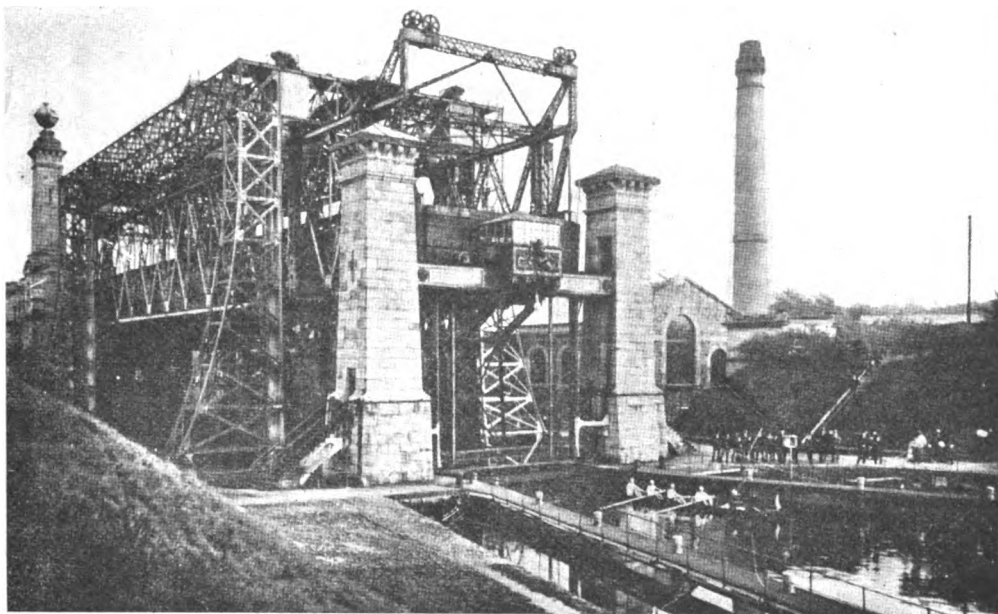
Impianto sollevamento porta lato canale inferiore.
